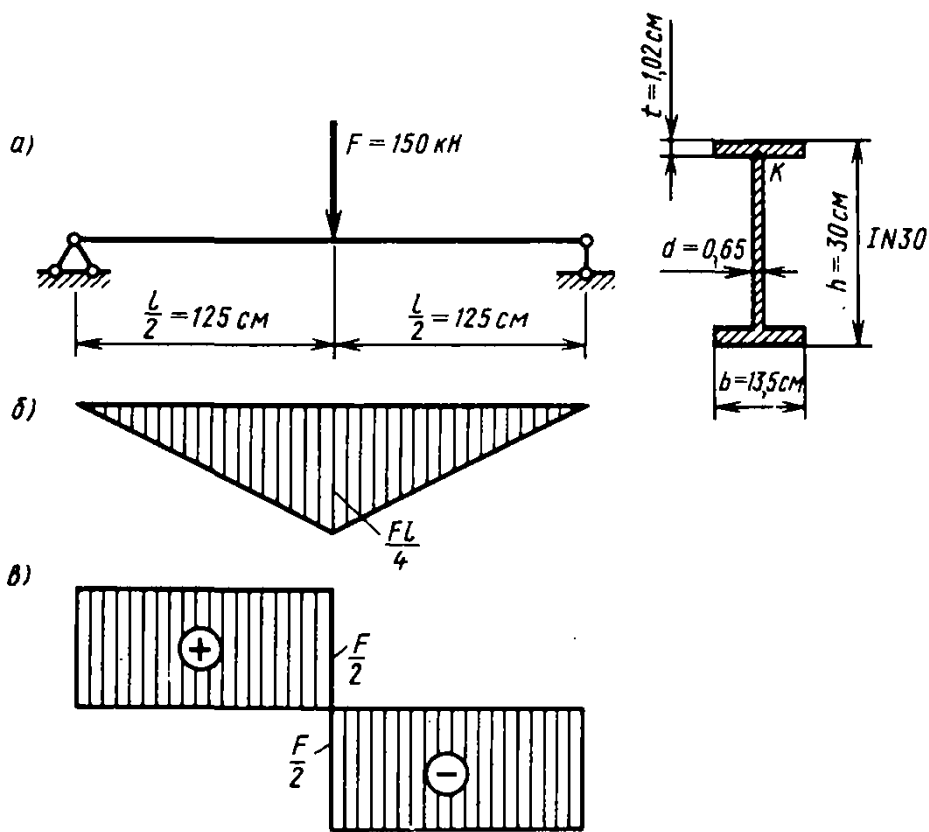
Расчетная схема подкрановой балки и эпюры изгибающих моментов и поперечных сил
